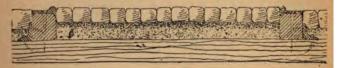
Coupe en travers de la voie de Philadelphie. Échelle 125
